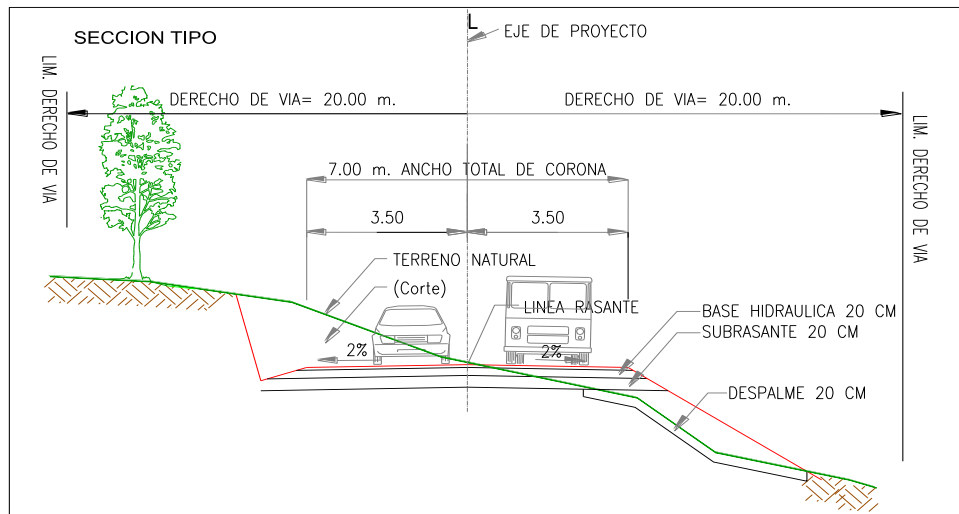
Corte transversal del diseño del pavimento rígido y proyecto geométrico.
